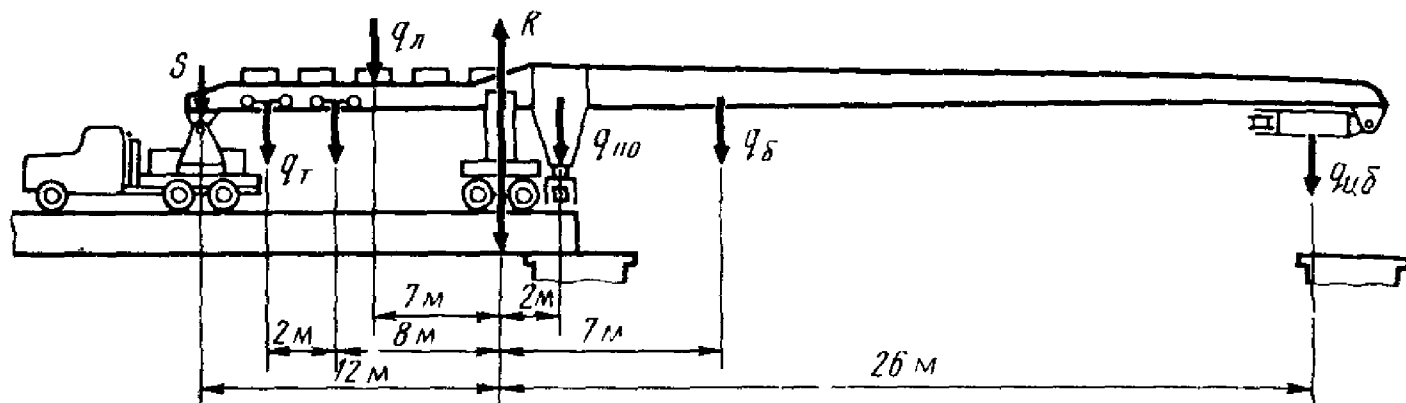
Расчетная схема при определении нагрузок от крана КШМ-40:
